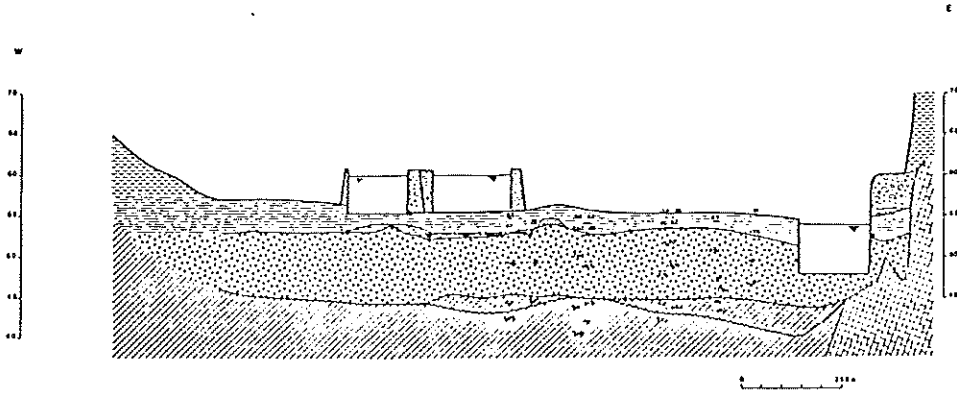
Coupe transversale CT 28, Basse-Hermalle
